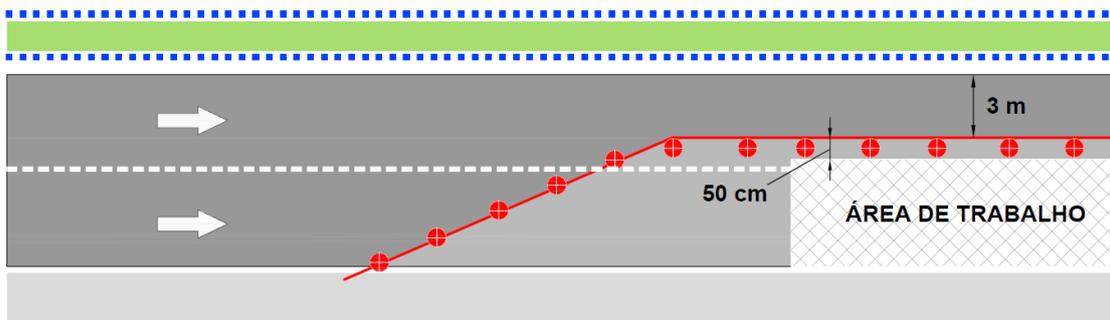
Posicionamento de dispositivos de canalização – Pista com 2 Faixas (caso 1)
